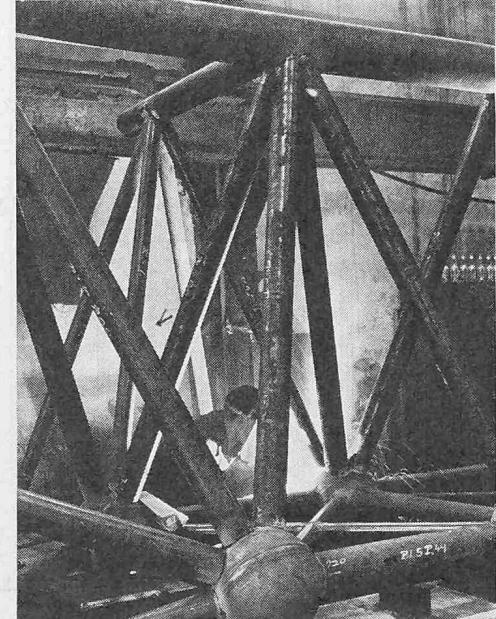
Rahmenecke mit Kugelschalenknoten während des Schweißens
